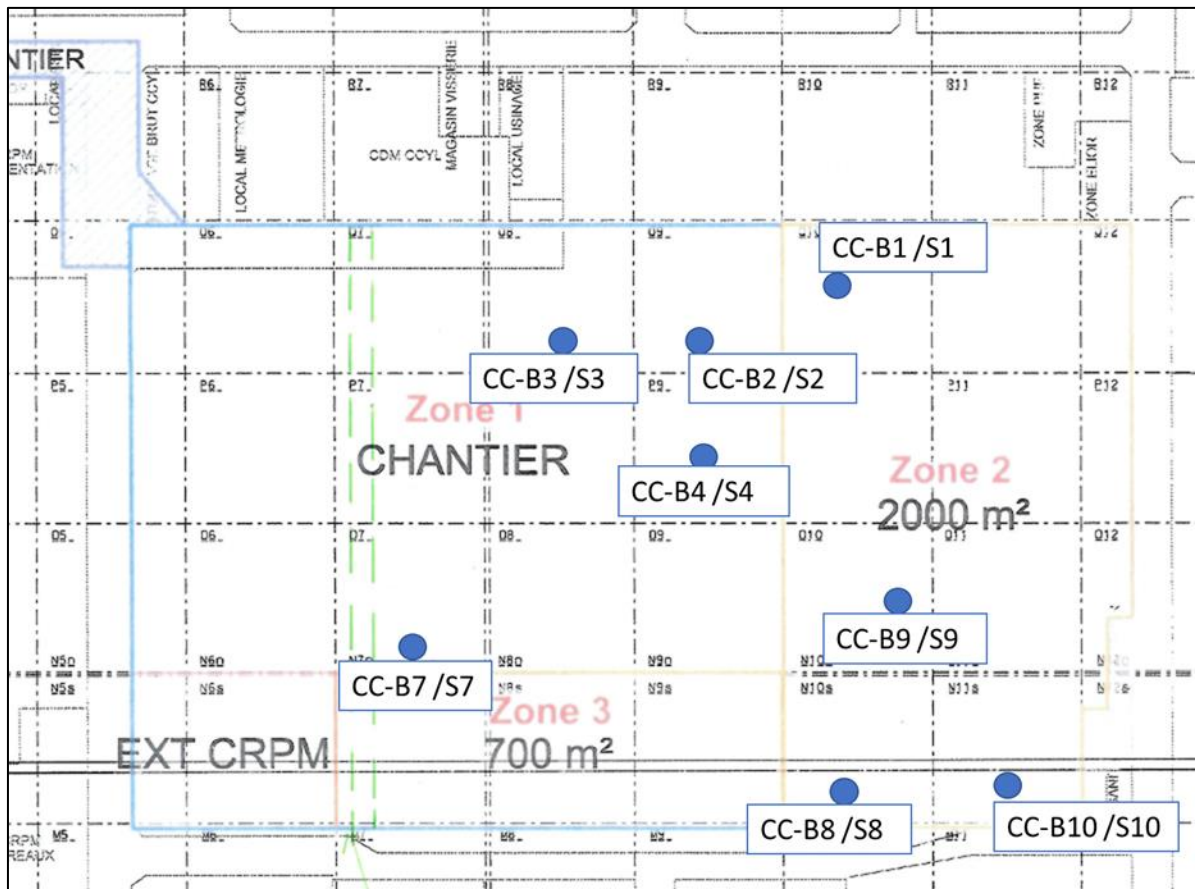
Plan de localisation de la première investigation au droit du bâtiment F (source : Rapport n°N2.15.100.0, SUEZ Janvier 2016)
